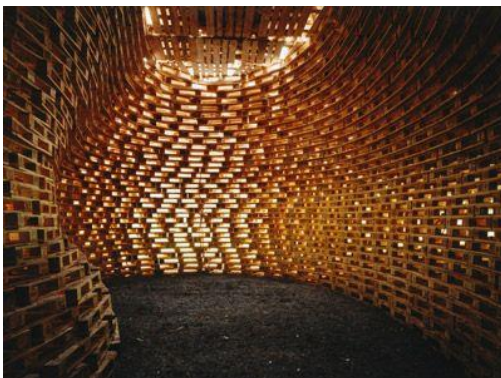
Palettenpavilion, pabellón temporal. Fuente. <https://www.pinterest.es/pin/507569820473001184/?lp=true>
